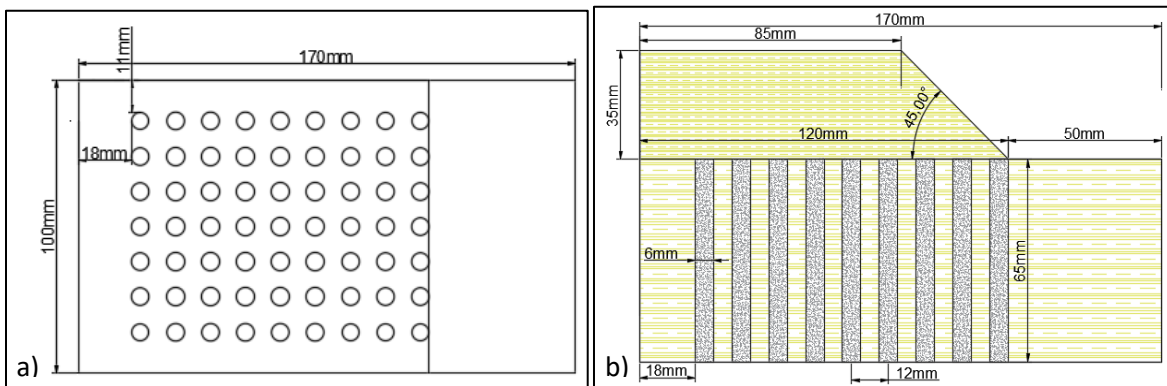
En a) vista en planta, en b) sección transversal de la distribución de columnas de suelo cemento de diámetro 0.6 m en el prototipo
